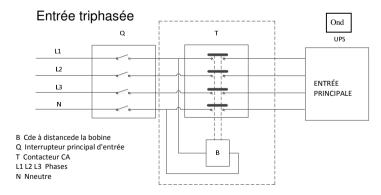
Installation type d'un dispositif d'isolement externe
